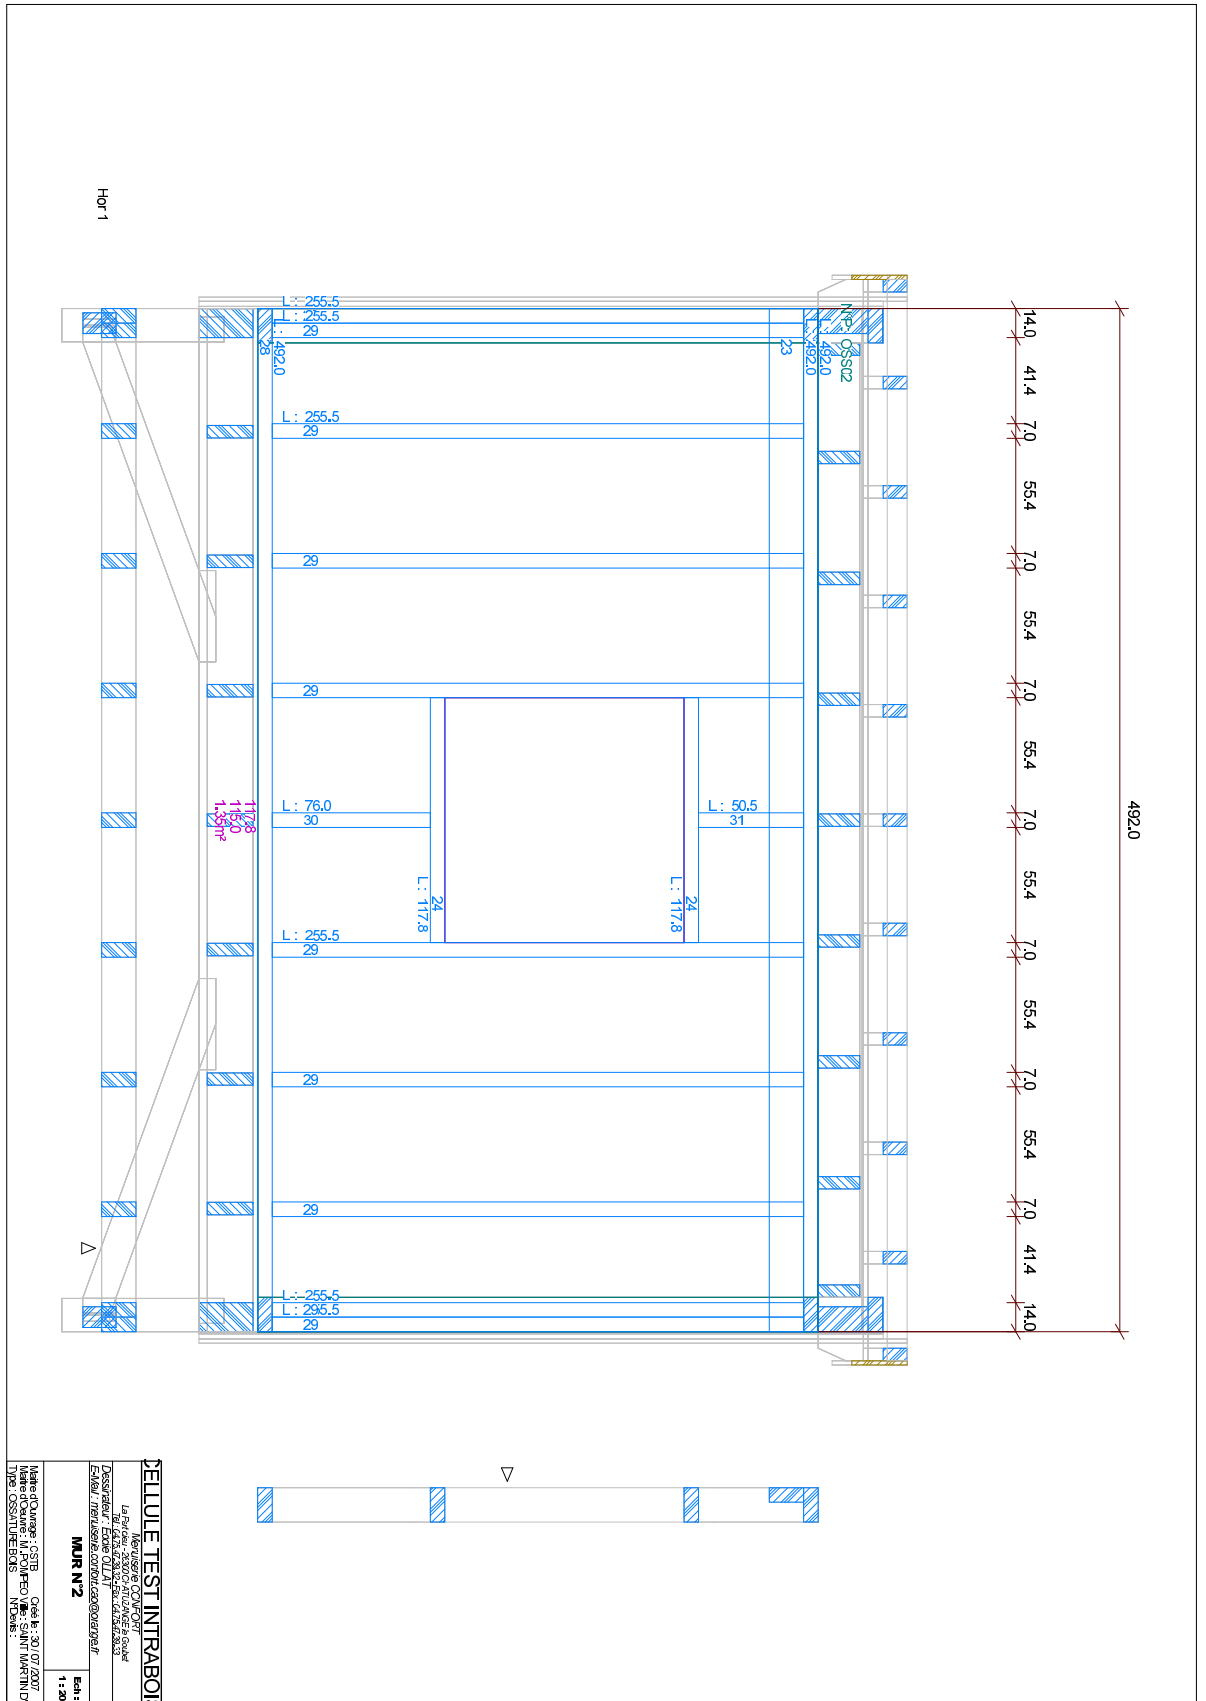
Vue en coupe verticale de l'ossature de la cellule, mur de façade Sud
